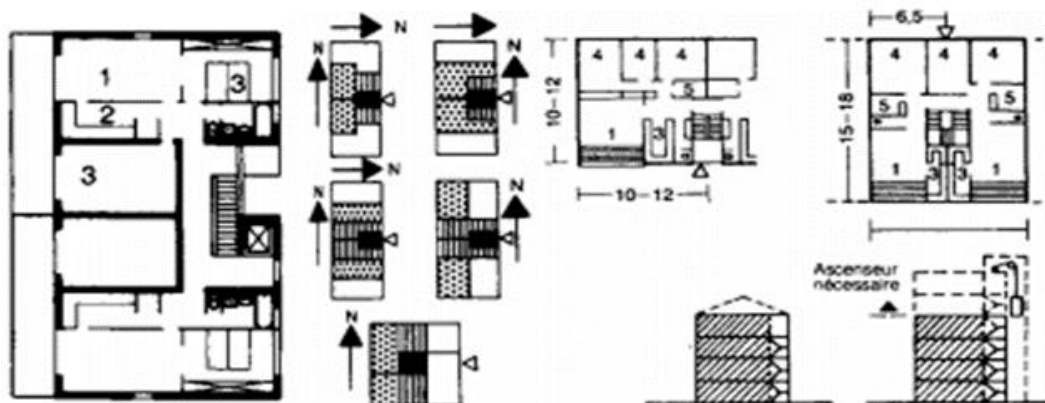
3: plan de 2 logs par étage Source : Neufert.
